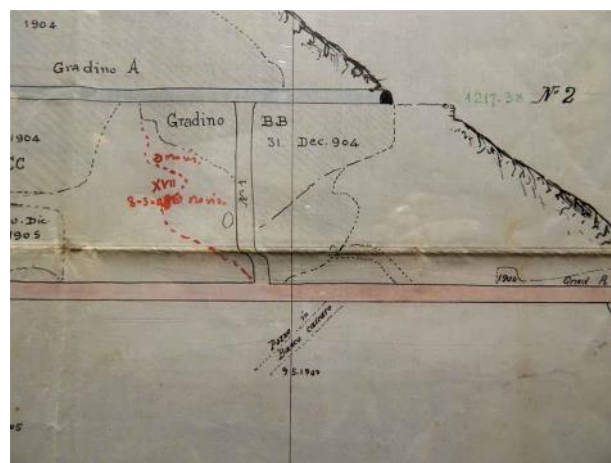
Miniera d'oro di Brusson ai primi del XX secolo; sezione: la galleria principale (inferiore) è connessa a quella superiore mediante un pozzo scavato attraverso il banco da coltivare (planimetria esposta all'ingresso turistico della Miniera d'Oro Chamousira a Brusson).
